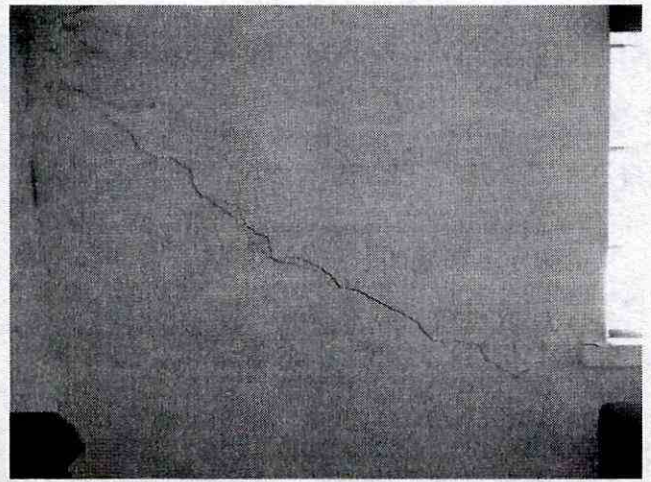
Se Observan las grietas de tendencia diagonal, en el muro de cerramiento del cuarto principal de la parroquia.
